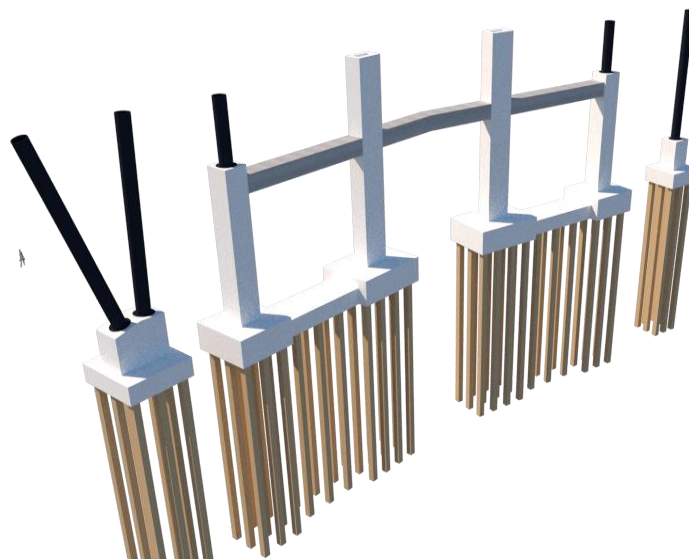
Render de cimentación de elementos principales en Estación 04
